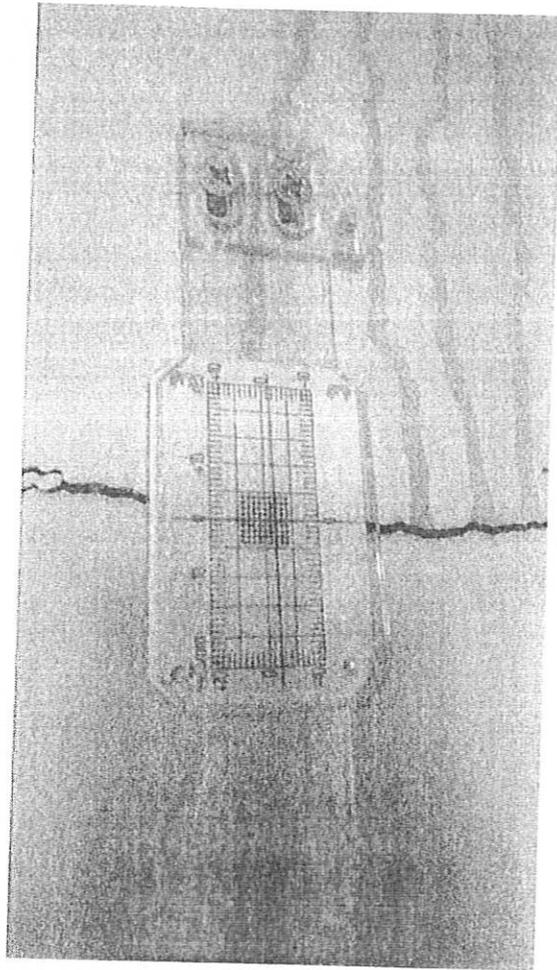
Fessurimetro nella zona angolare nord-ovest del complesso
